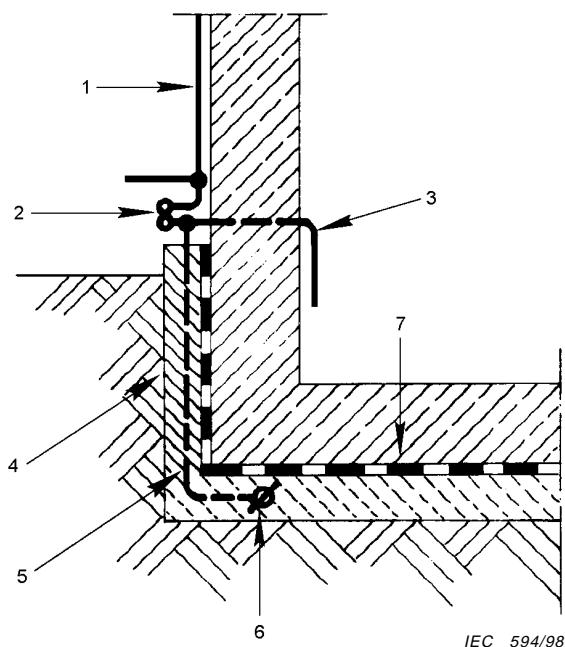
Fondation isolée avec prise de terre à fond de fouille dans une couche en béton non armé sous l'isolation bitumée
